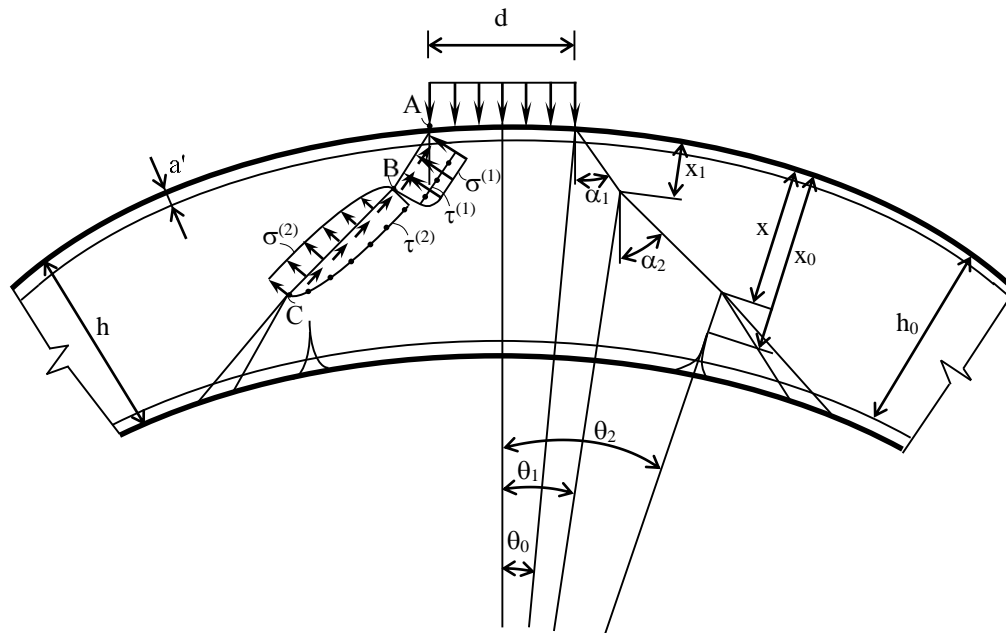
Экспериментально обоснованная локальная схема разрушения железобетонной оболочки
